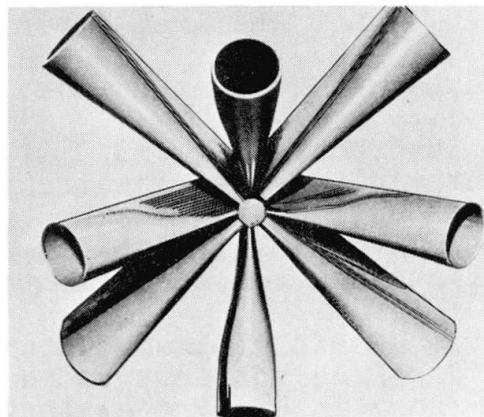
Wannengeschweissster Knoten einer Strukturkonstruktion
